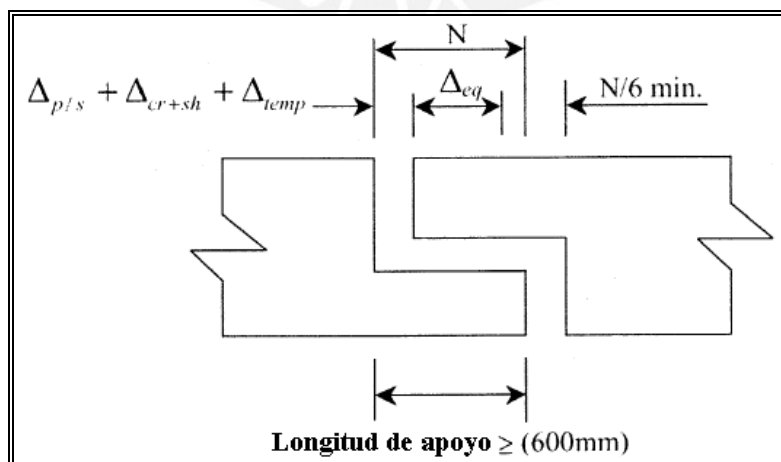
Ancho de apoyo de una articulación dentro de tramo (CALTRANS).
